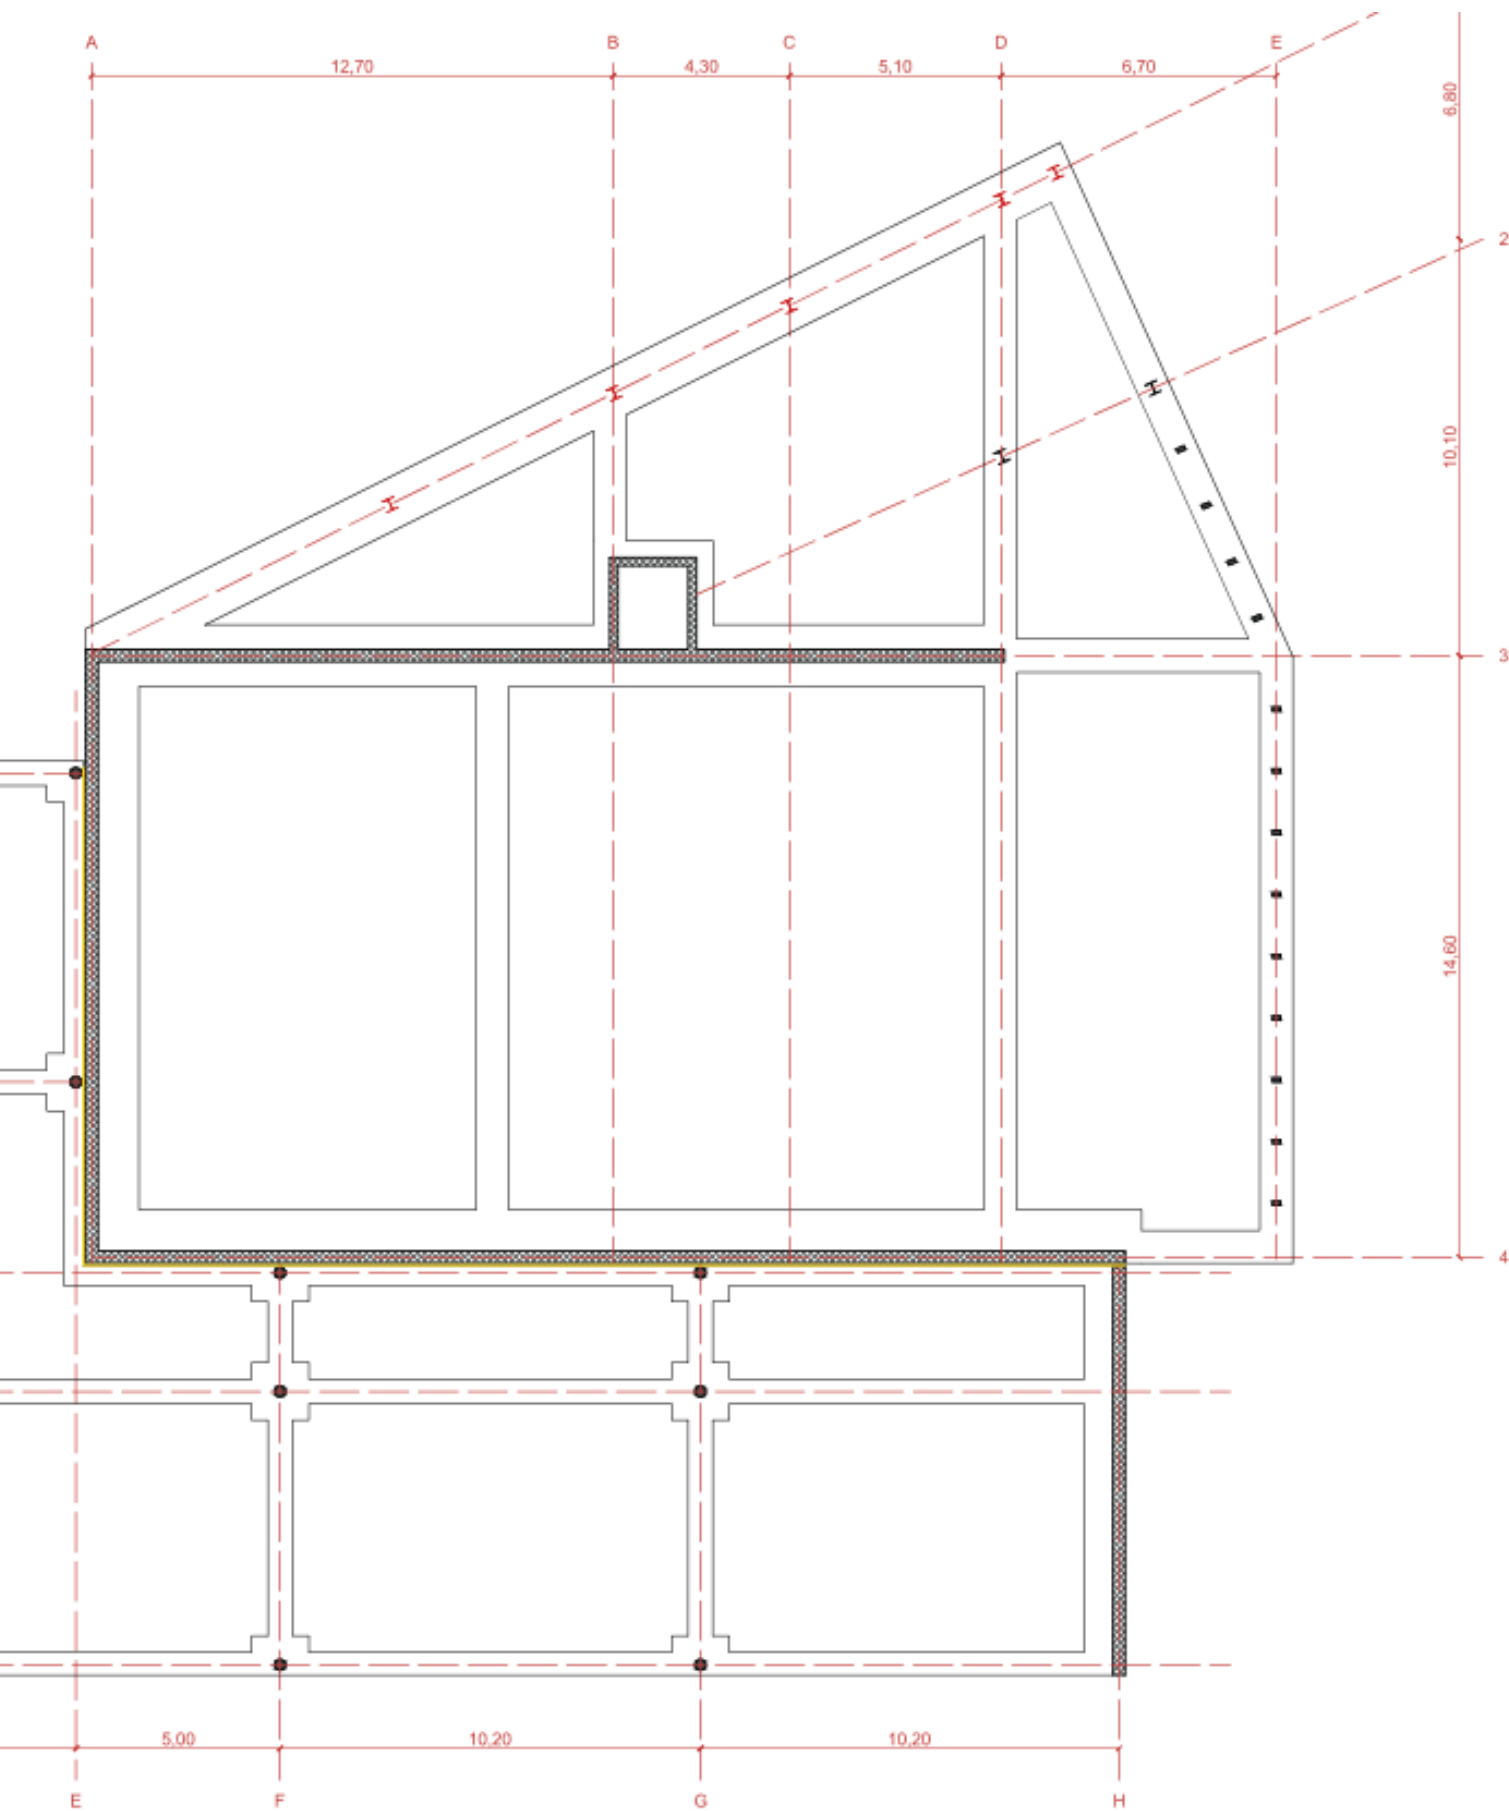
Pianta fondazione edifici auditorium/museo
